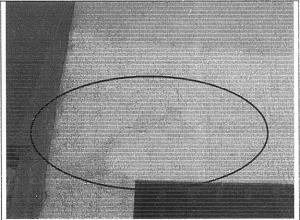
Fisura en extremo norte del muro de fachada
